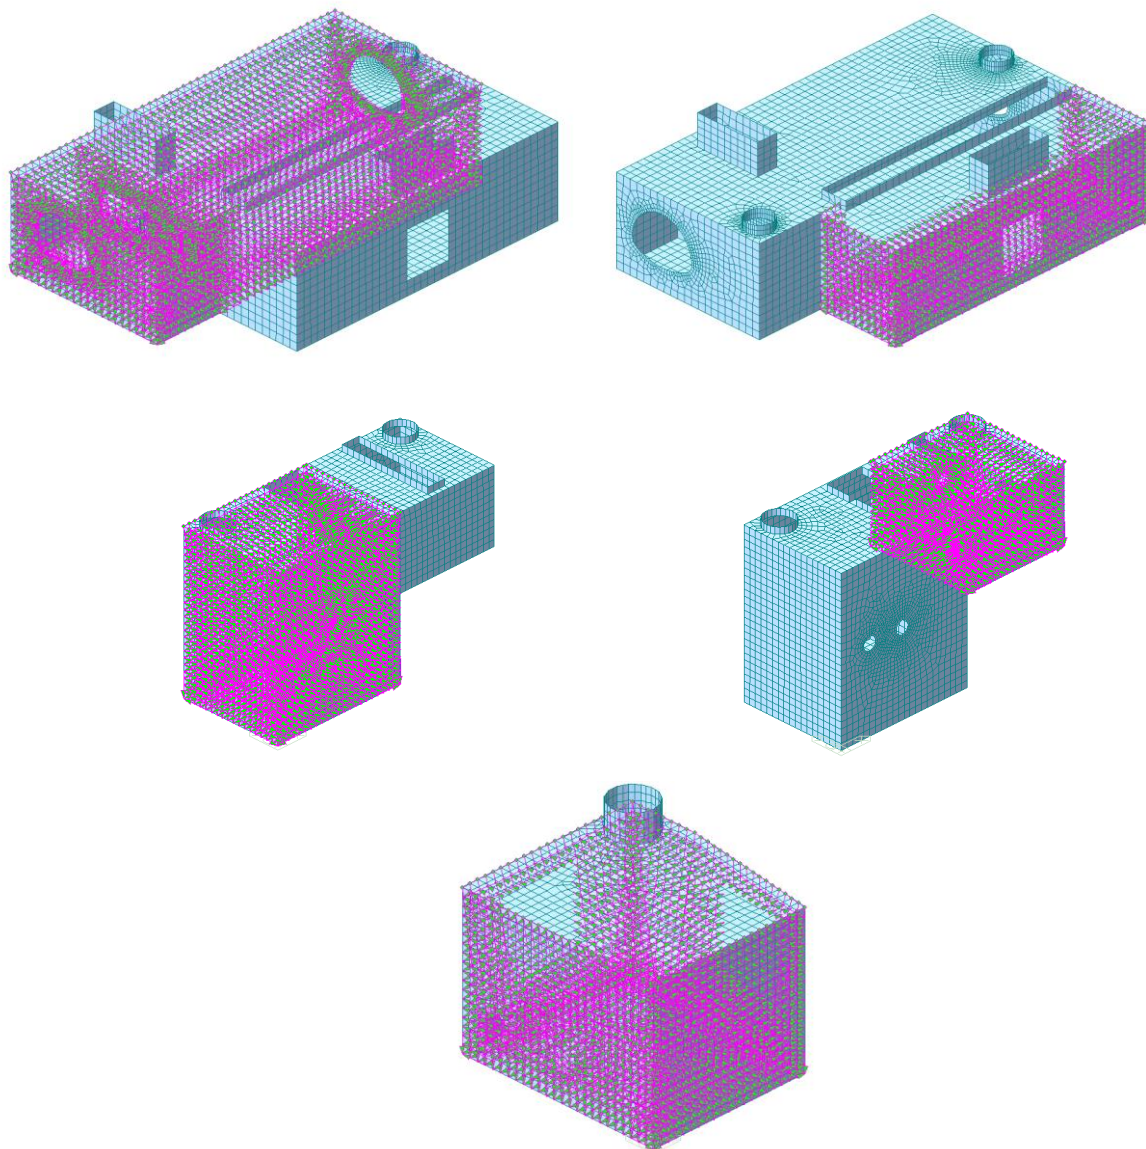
Spinta dell'acqua: sopra cameretta di sfioro, centro cameretta di sollevamento e sotto pozzetto ripartitore.
